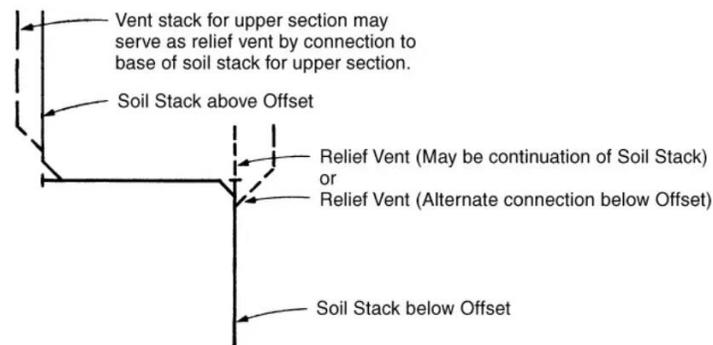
Primera configuración de ventilación de alivio en cambio de dirección de bajante tomado de (Steele, 1982)
